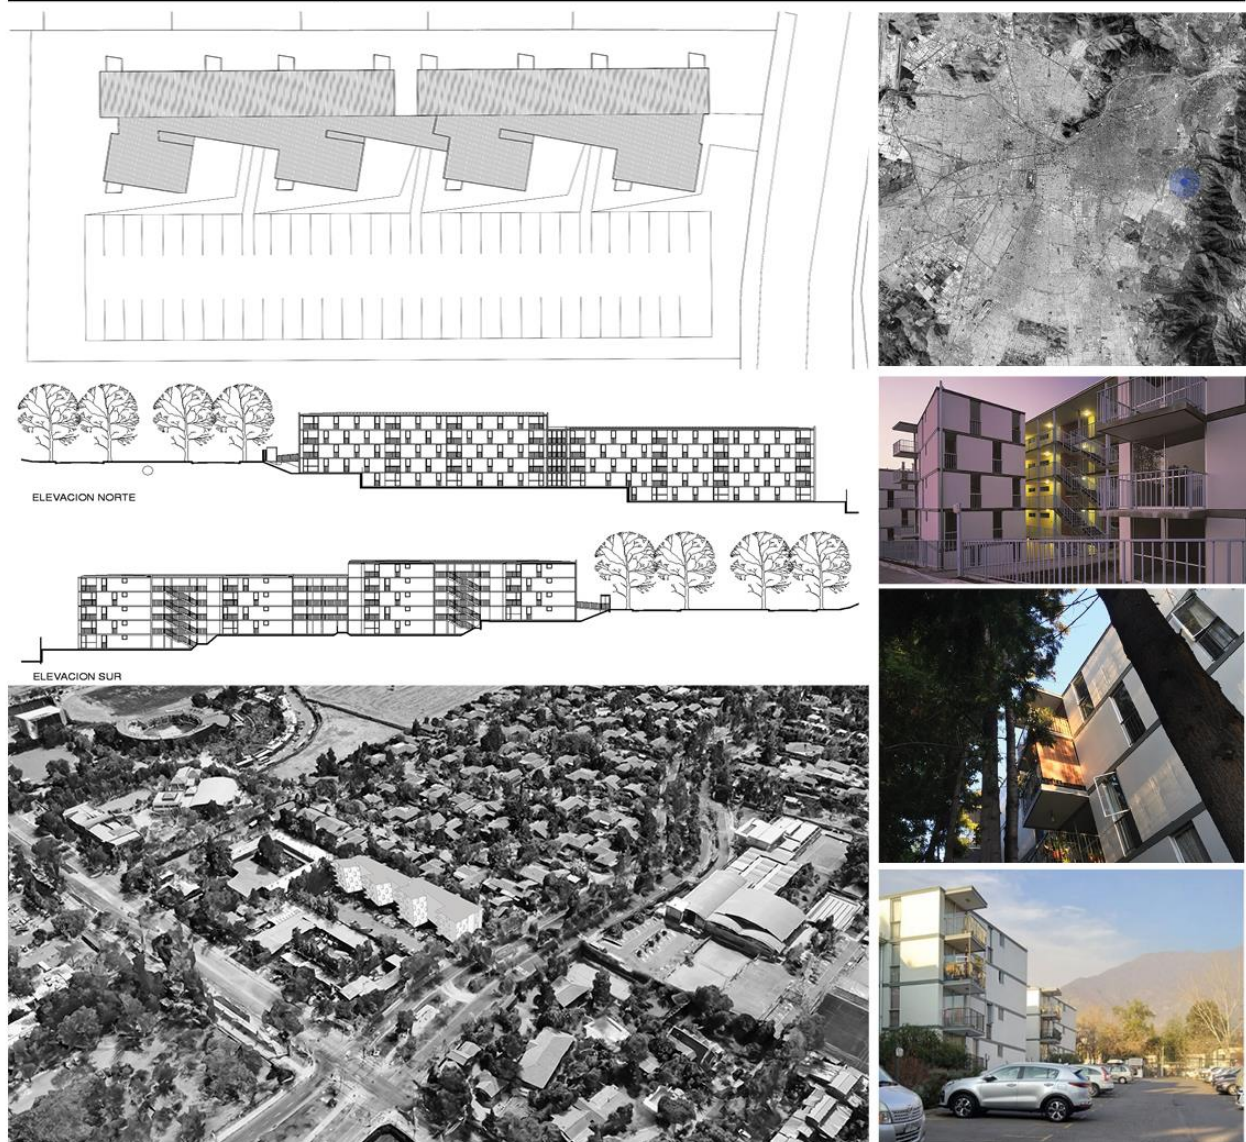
Ficha Conjunto Habitacional Funcionarios de La Reina./ Planta conjunto, plano ubicación y vista aérea: elaboración propia. / Imágenes 1y 2 y planimetría vivienda: gentileza arquitecto Humberto Eliash. Imagen 3: Archivo de la autora.
